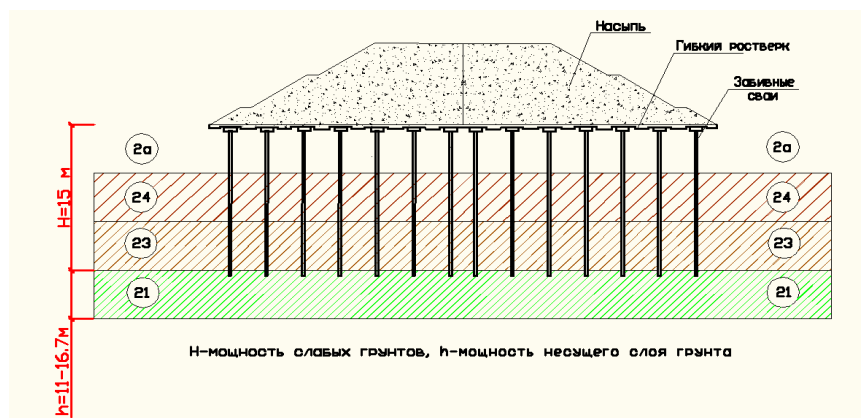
Устройство свайного основания с гибким железобетонным ростверком
